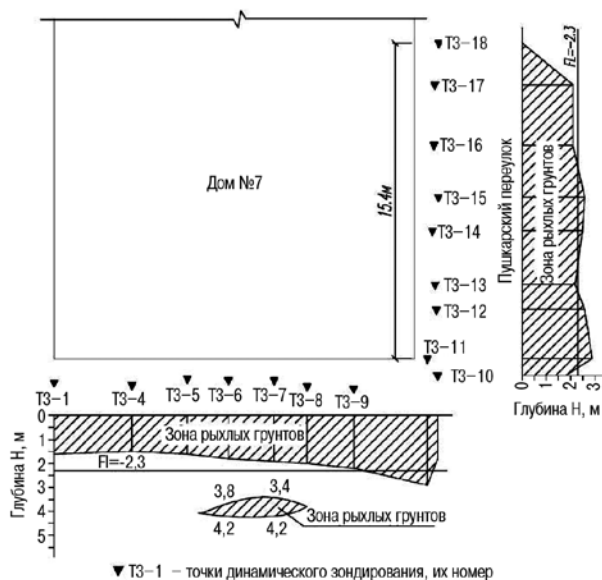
Эпюры зон разуплотнения грунтов под фундаментами дома № 7 по Пушкарскому переулку
